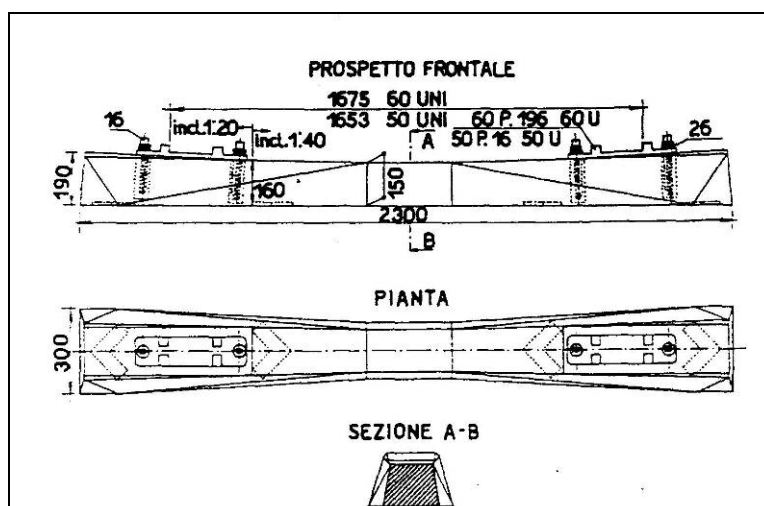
Traversa in cemento armato vibrato precompresso, tipo FS
